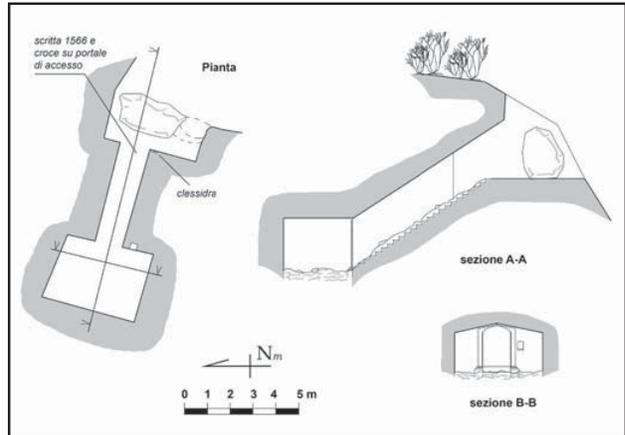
Planimetria e sezione della Cavità n. 45, "Chiesa di San Giovanni" (Copyright CRSE).
